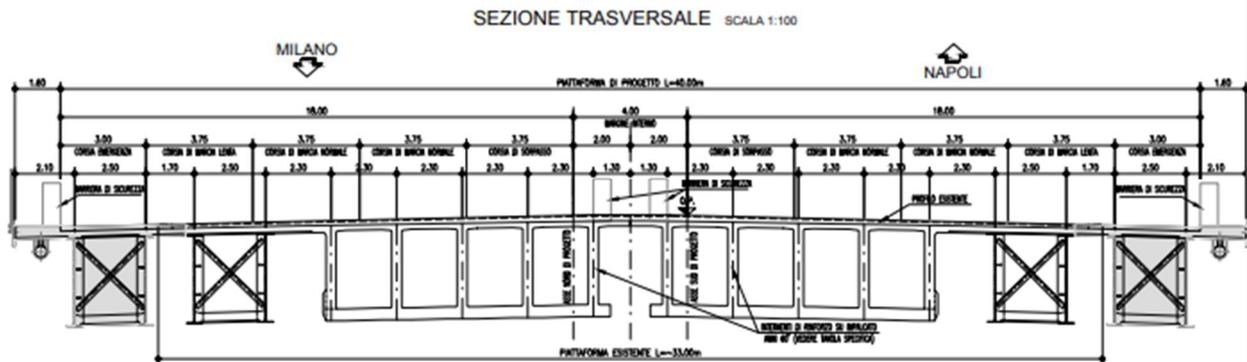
Sezione trasversale Viadotto Lambro – configurazione approvata
